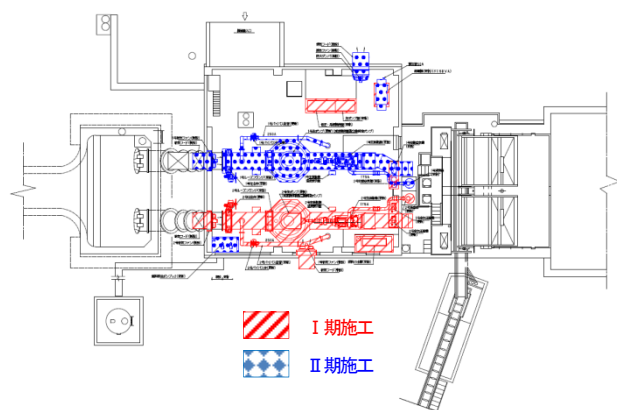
施工範囲図 (Ⅰ期, Ⅱ期)
